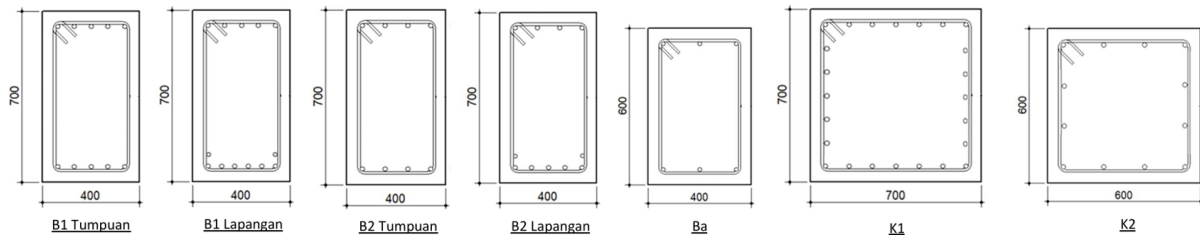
Tipikal denah balok dan kolom lantai 1-6
